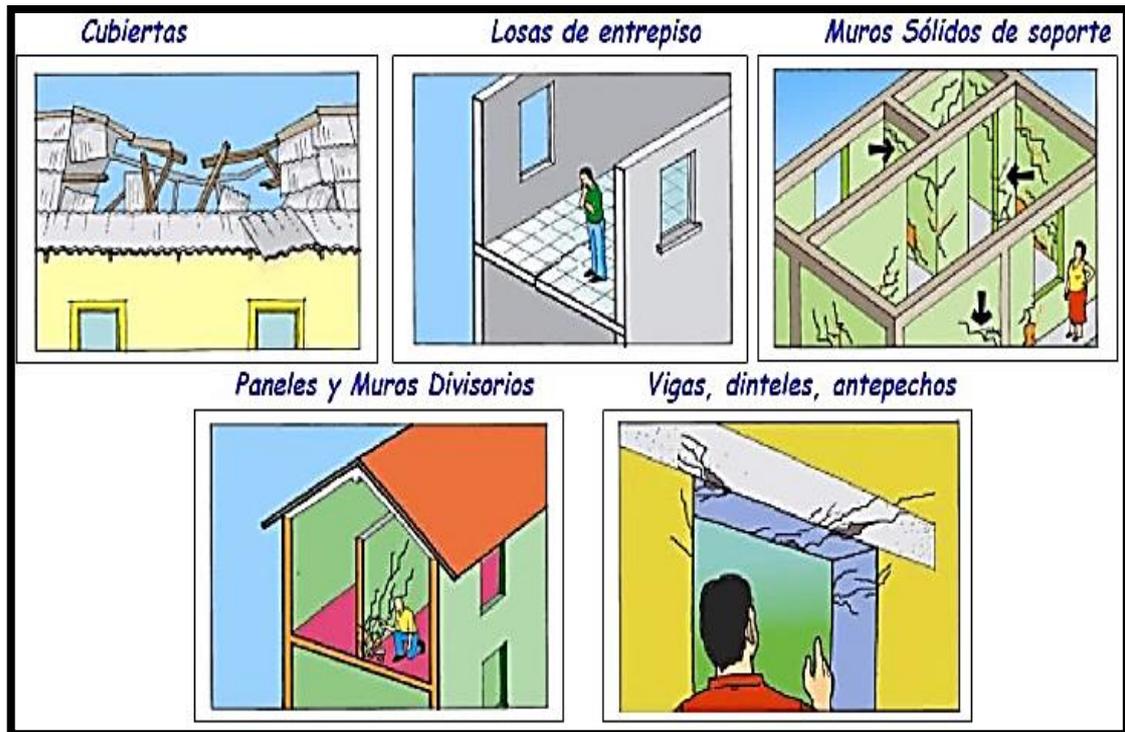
Ejemplo de estado de conservación de la estructura.
